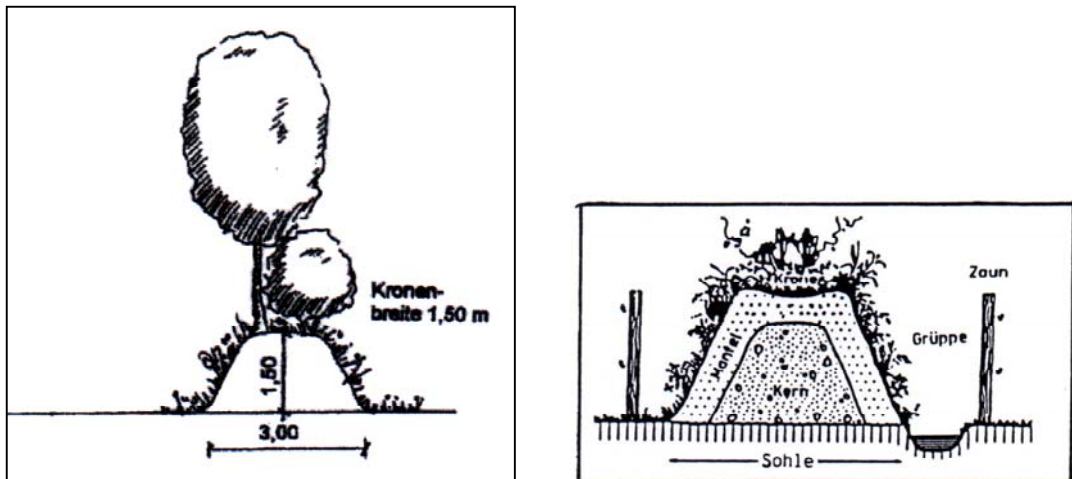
Aufbau und Querschnitt einer Wallhecke (schematisch)
